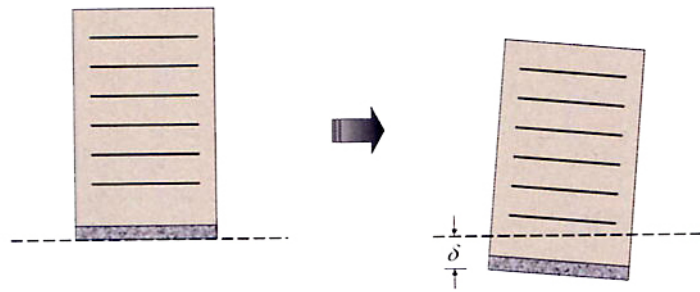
Idealización del estado de servicio del proyecto con cajón de cimentación.
